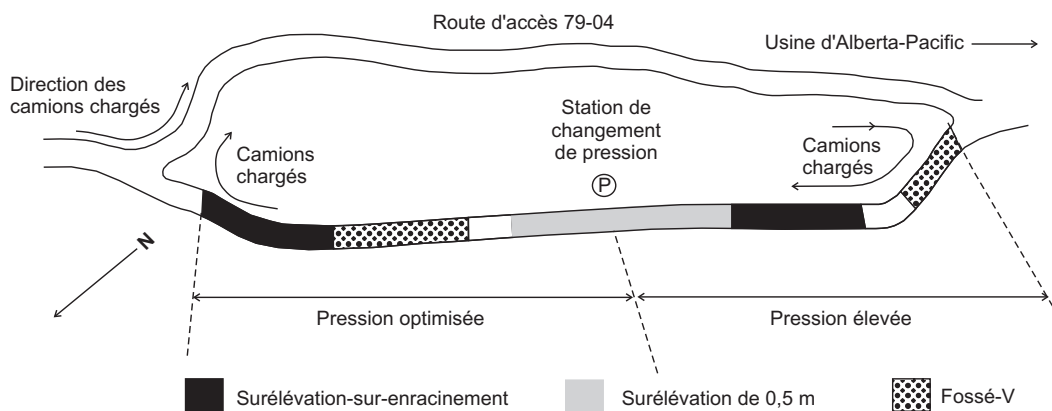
Vue en plan de la route vieillie, montrant les sections d'essai.
